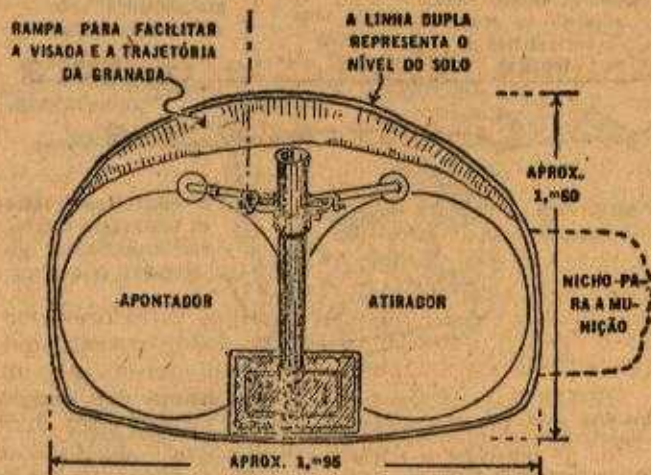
Espaldão para morteiro de 81 mm, visto de cima
